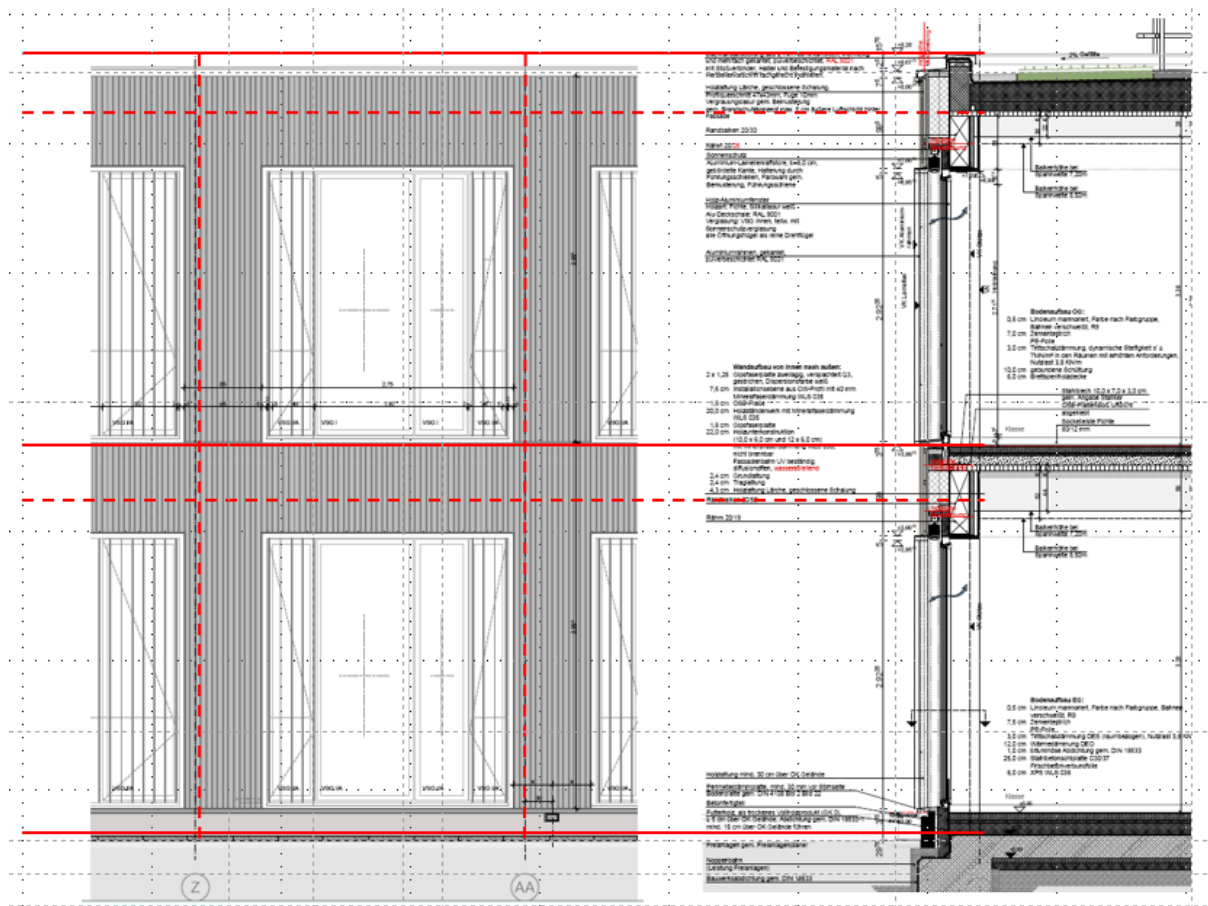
Elementierung der Fassade von Haupt- und Lernhaus (Ausschnitt)
